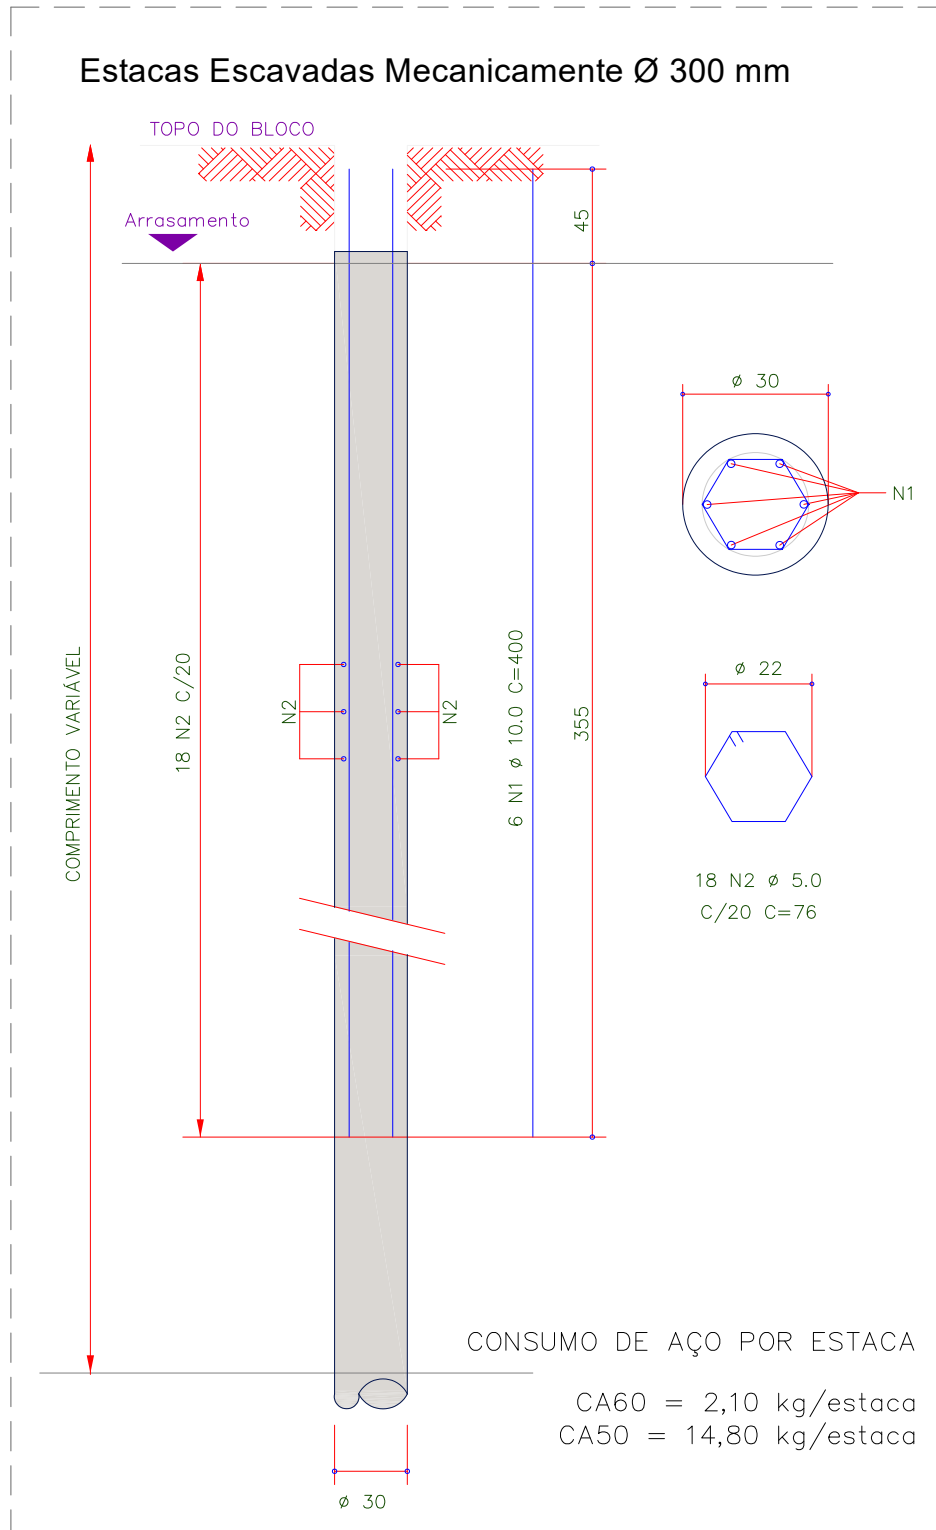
Detalhamento das Armaduras das Estacas Escavadas Mecanicamente D300
